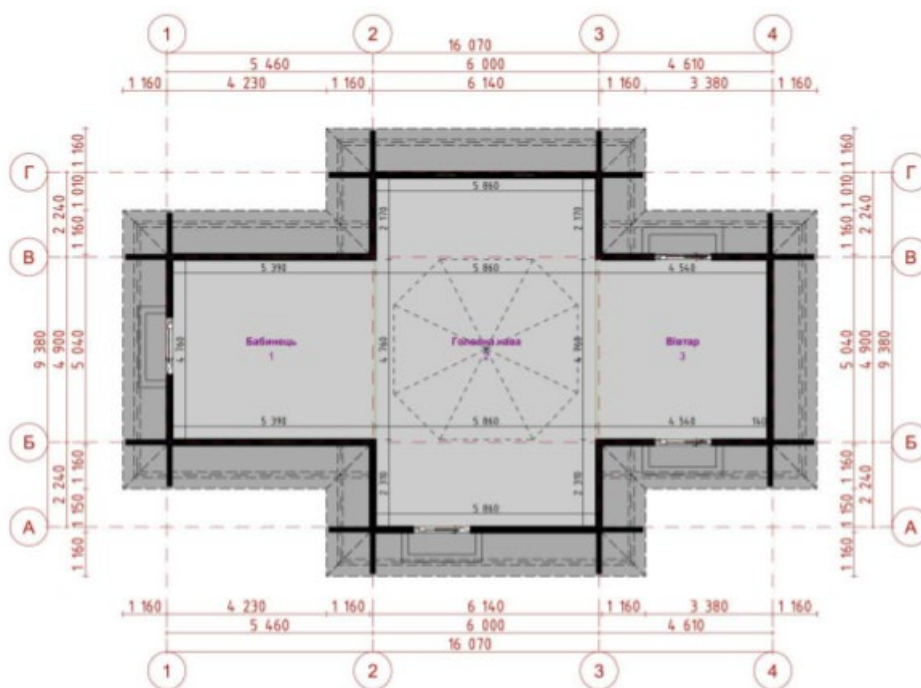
Теоретична реконструкція плану будівлі храму станом на XVIII ст.
